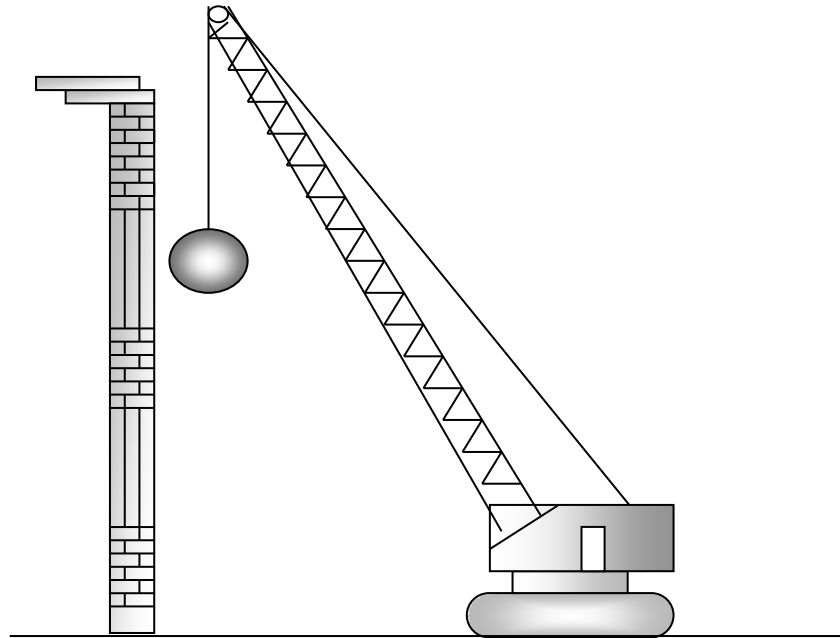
Руйнування нестійких конструкцій сталевим шаром
